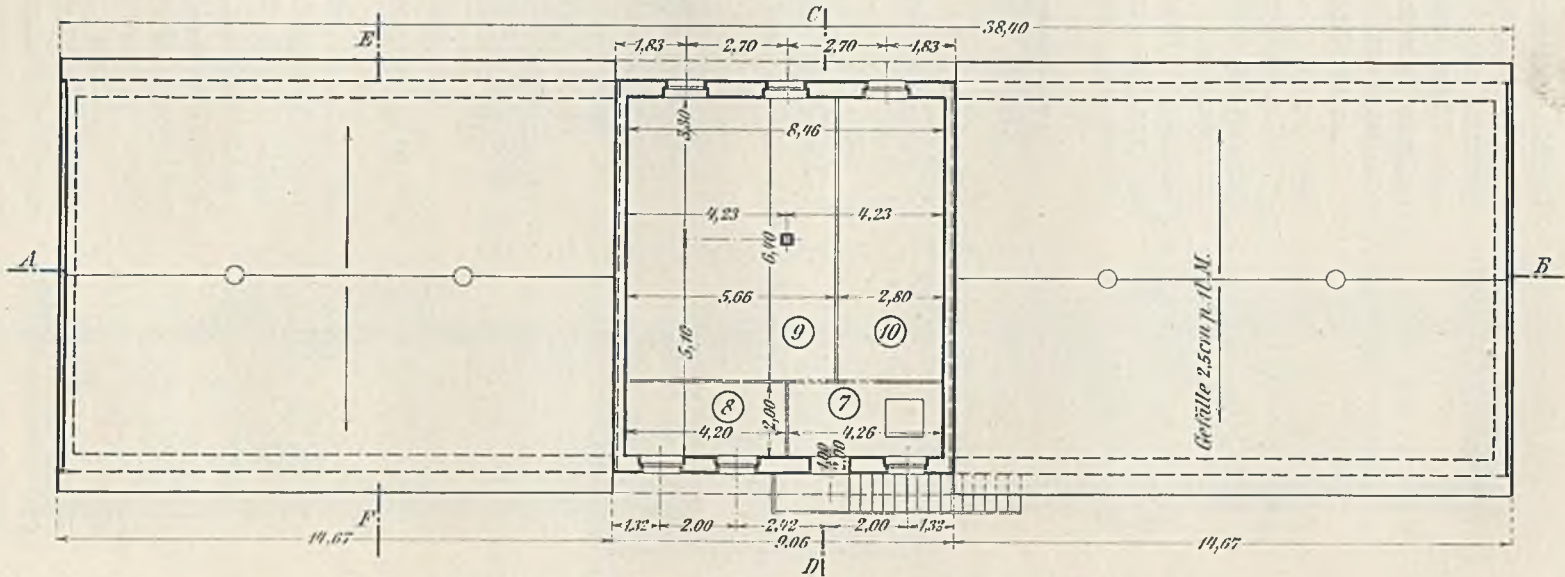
Stallbaracke in Tolmein. Grundriß Obergeschoß.
